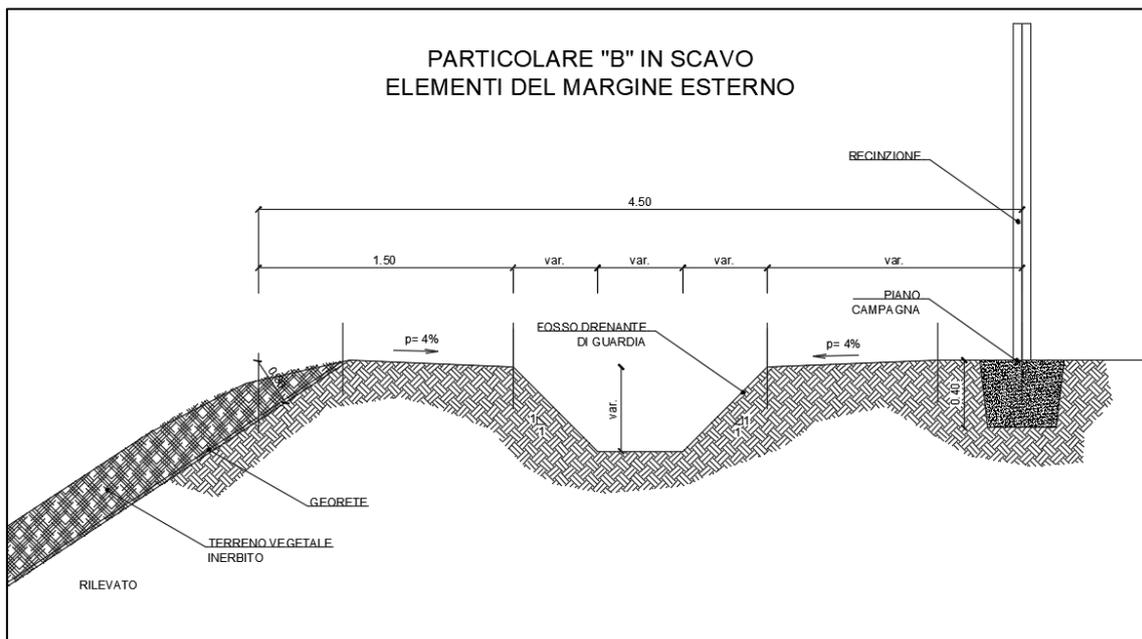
Sistema di scarico in scavo – fosso in testa
